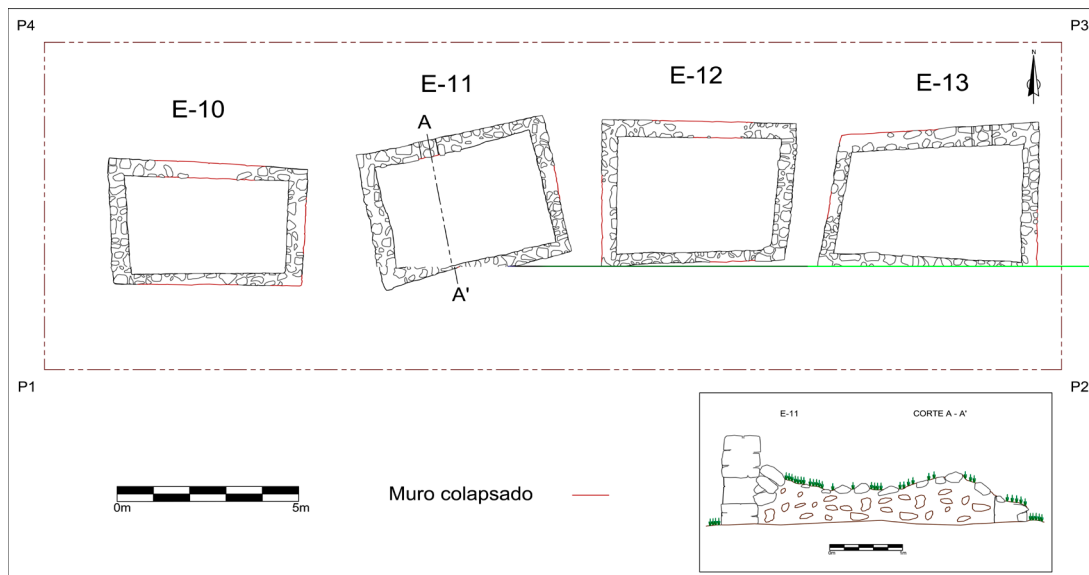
Vista en planta de cuatro construcciones. E-11 y E-13 conservan un vano.
